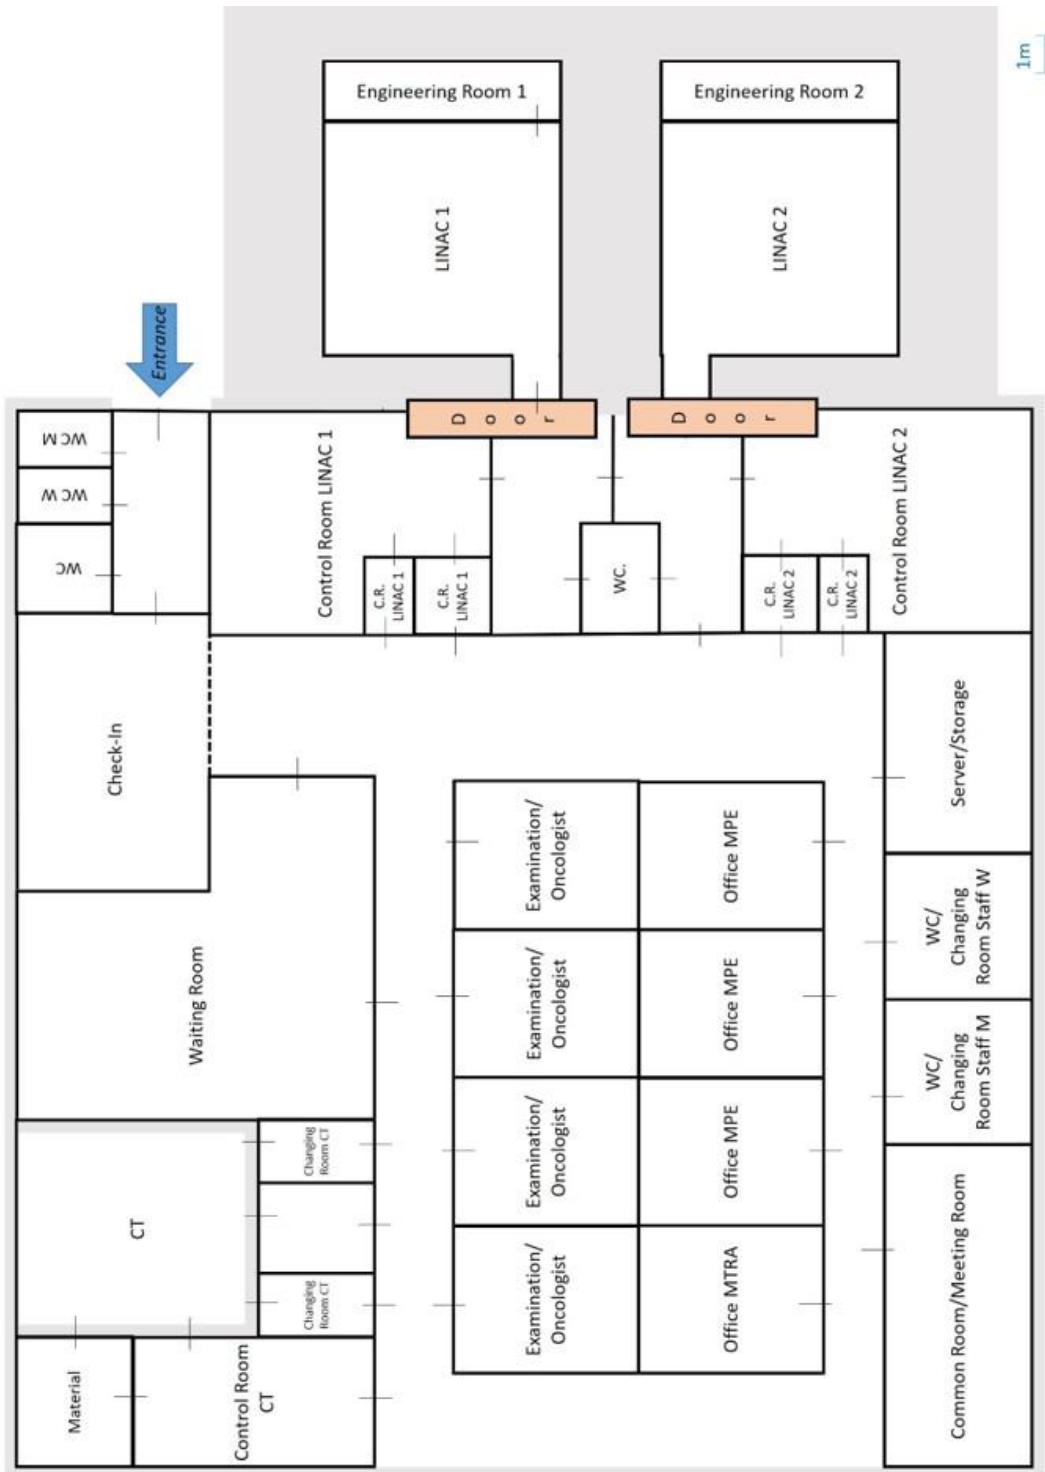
Eigener Entwurf eines Grundrisses einer Strahlentherapieeinrichtung in Grundausrüstung.
